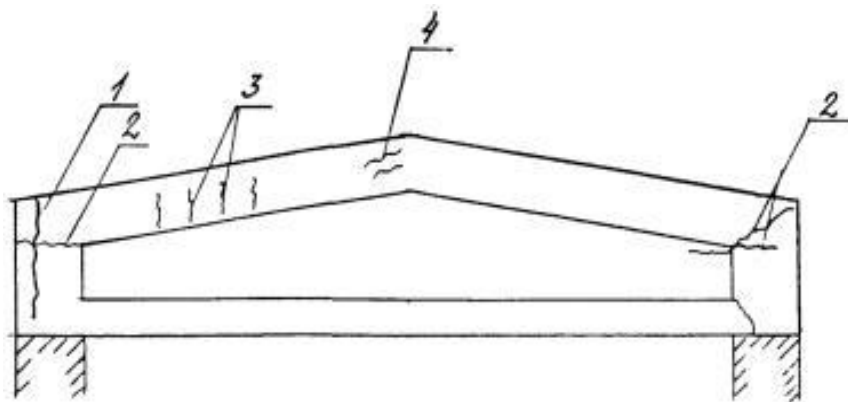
Трещины в железобетонной балке покрытия
